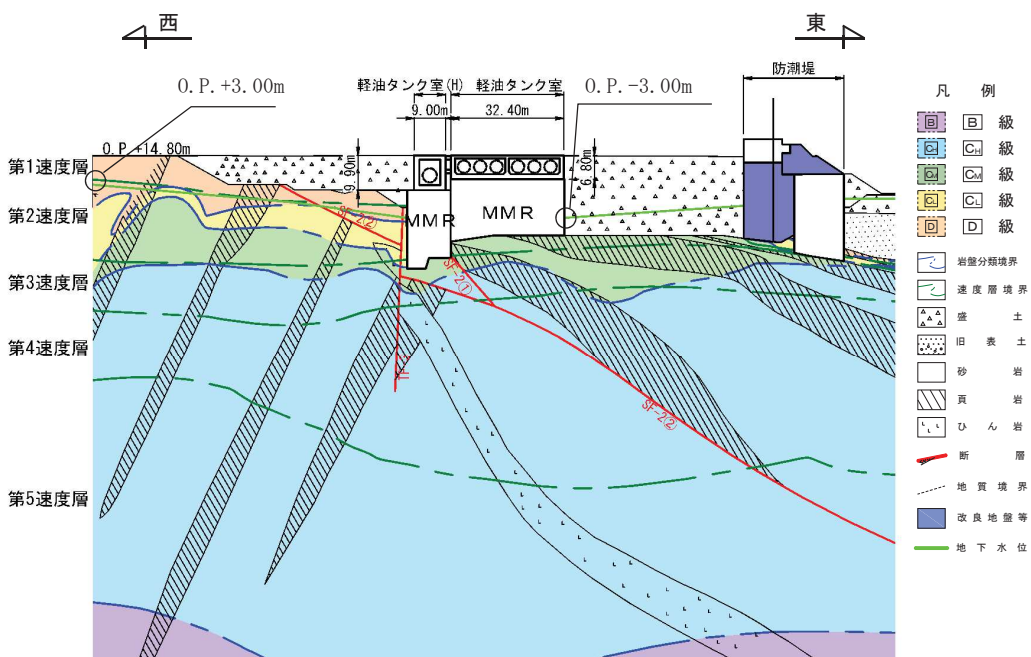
軽油タンク室 地震時荷重算出用地質断面図
